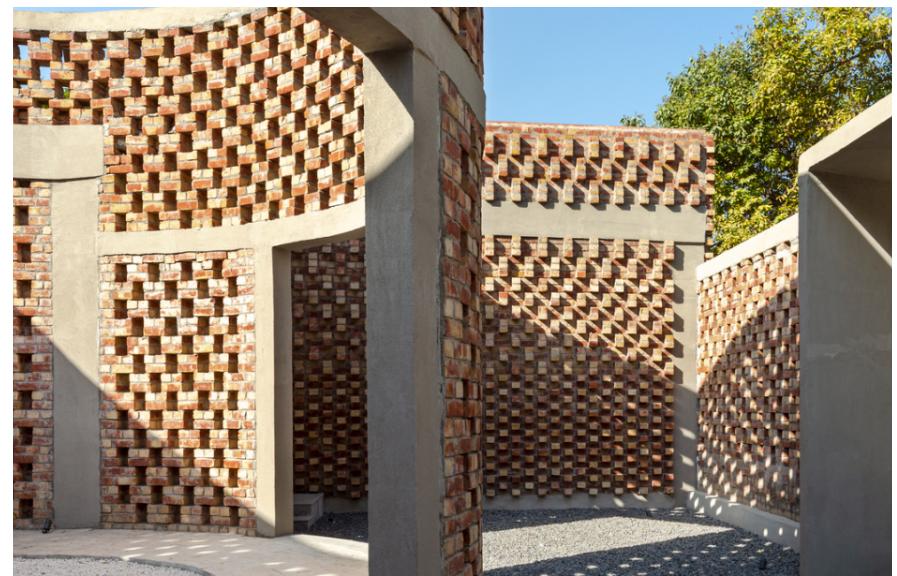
Detalhe Fachada: Brise Soleil (Fachada Sul):
